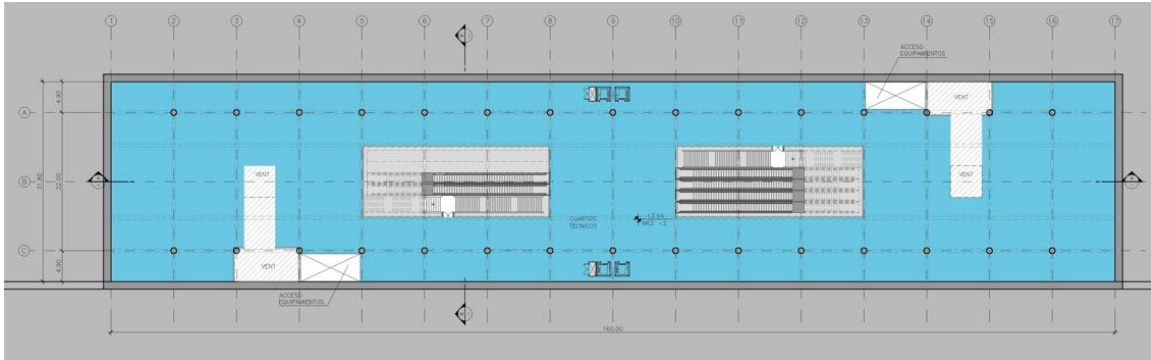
Planta Estación 1 Nivel intermedio -2 (-13,94)
